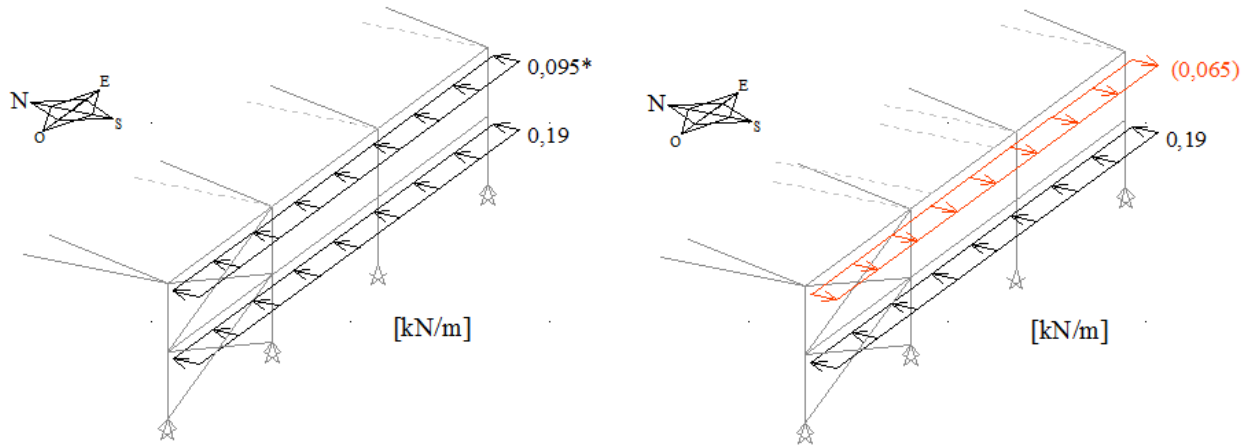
Vento W1 na fachada orientada a Sul na situação 2 (RSA)
